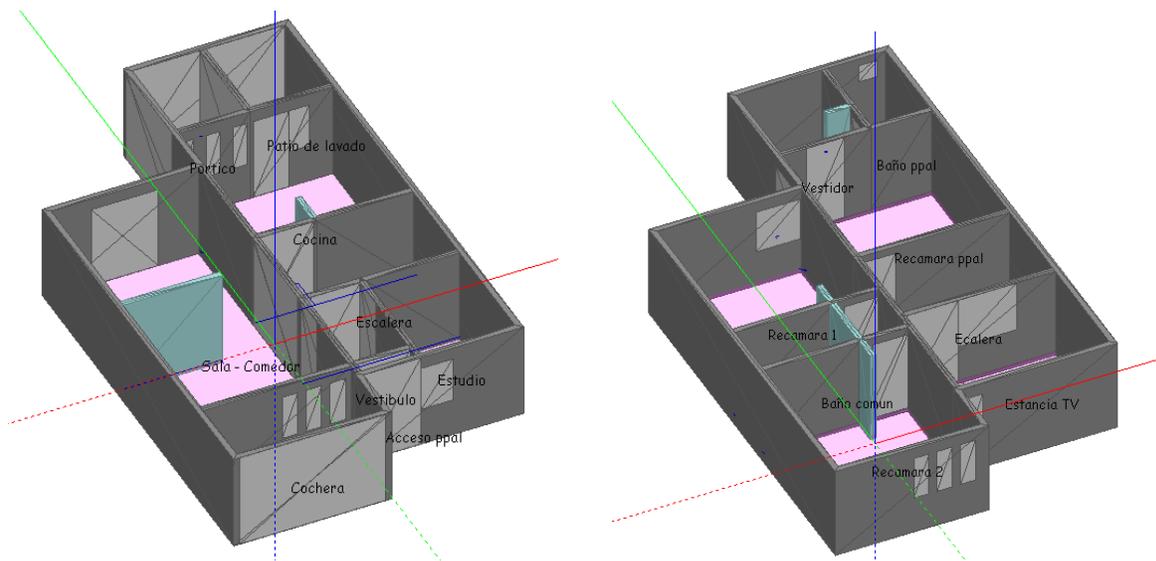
Modelo de la planta baja y planta alta del prototipo seleccionado para la simulación.
